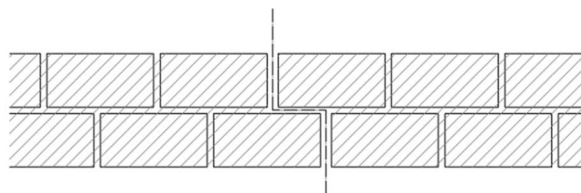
Junta de movimiento con solape. Esquema en planta
